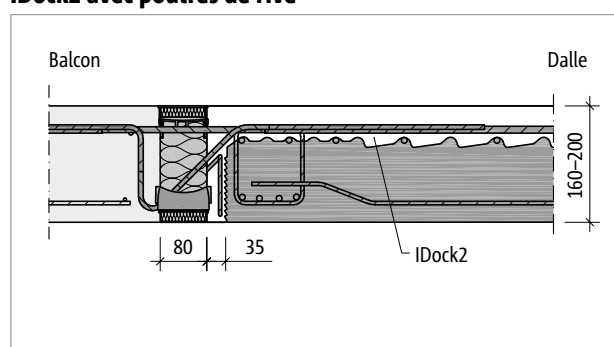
Schöck Isokorb® T Type K-E : Raccordement de balcons avec des épaisseurs de panneaux de 160 mm à 200 mm avec IDock2
